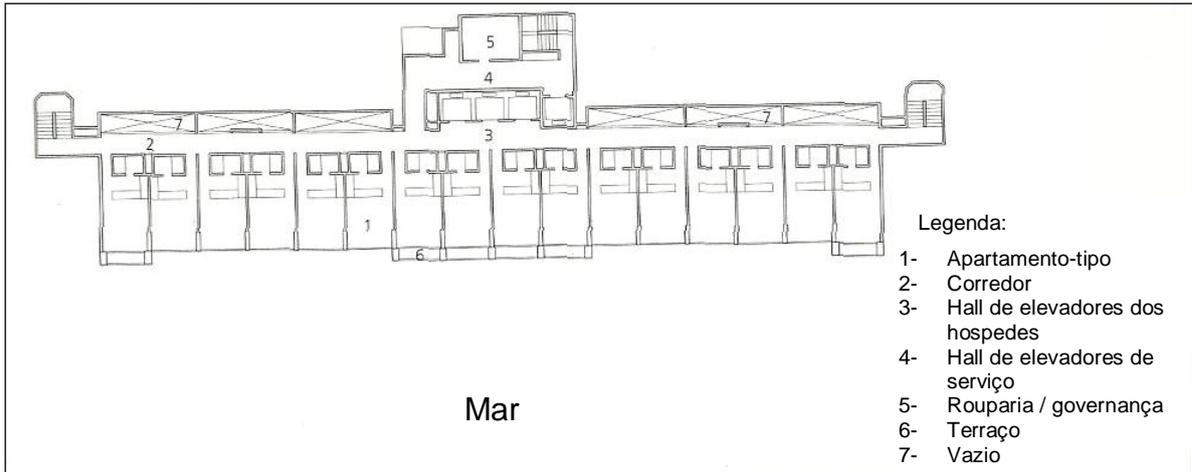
Planta Baixa Hotel Best Western Porto do Sol, Vitória; ES.
